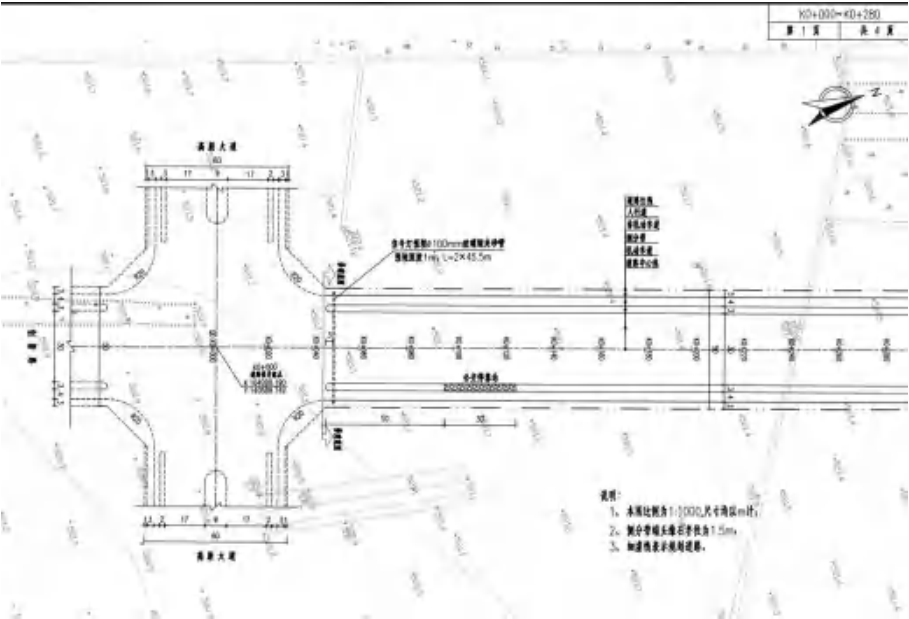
本工程与高新大道连接线的工程衔接方案平面布置图
